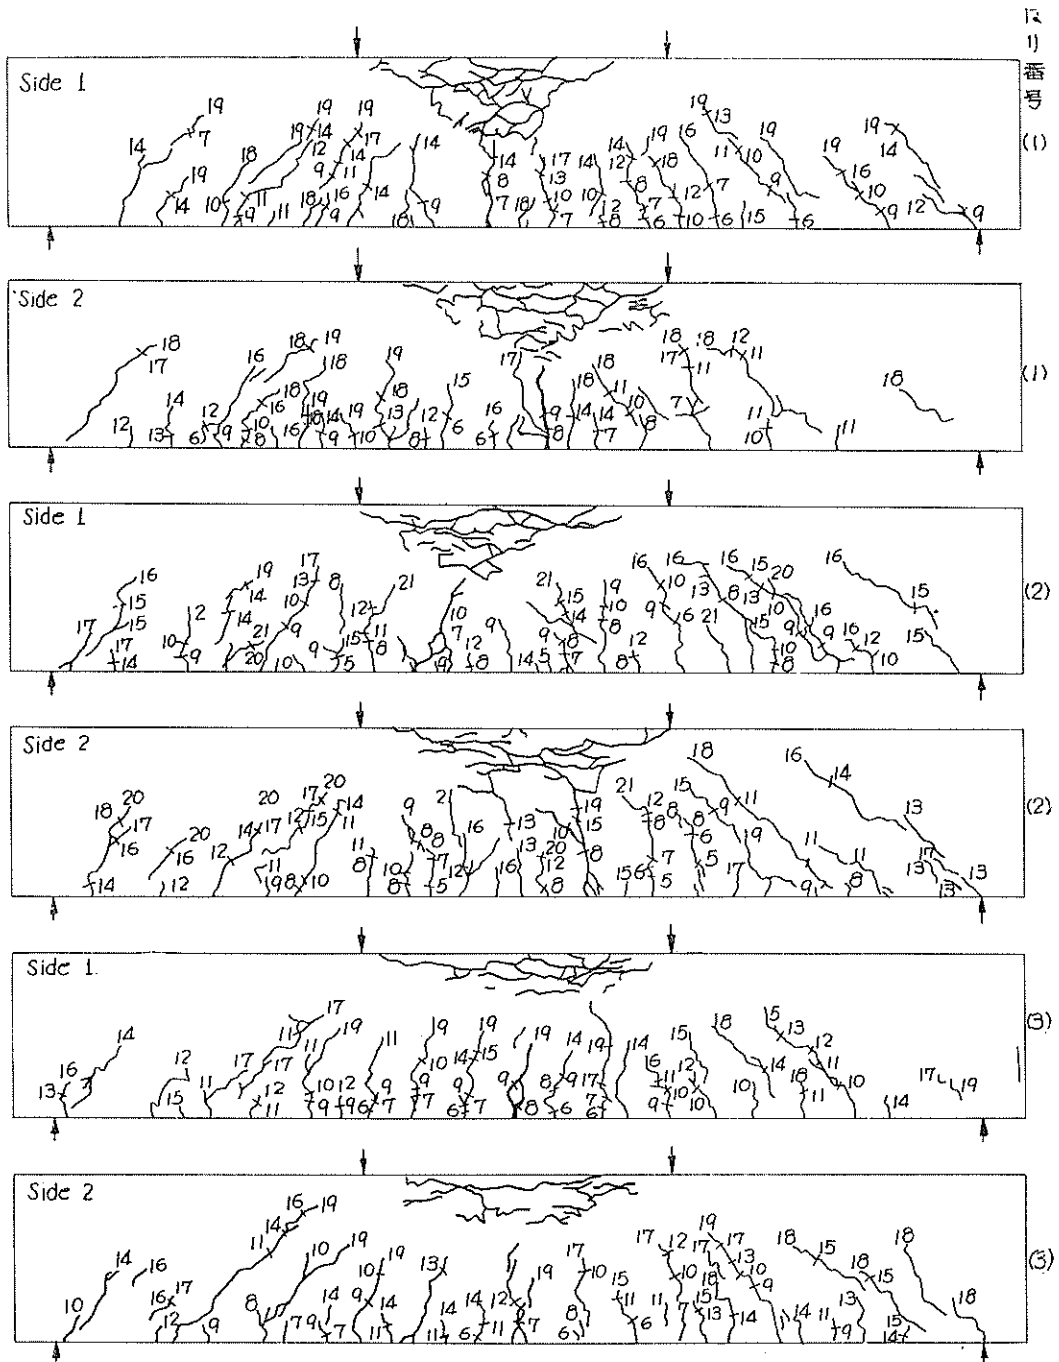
鉄筋プレキャストコンクリートばりのひびわれ状態
